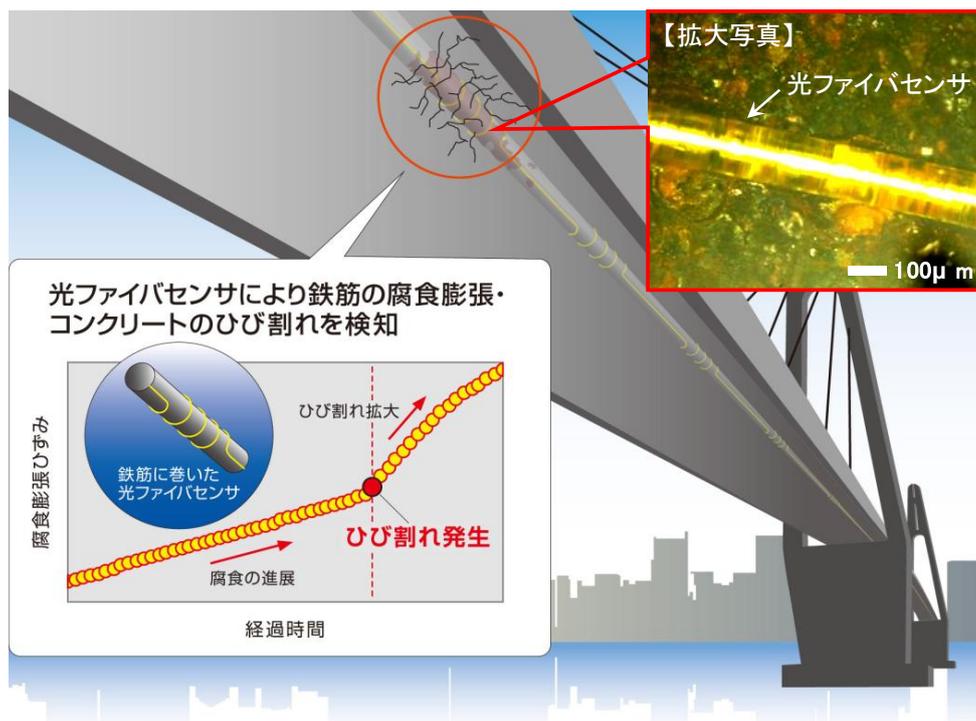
社会実装のイメージ（鉄筋の腐食膨張およびコンクリートのひび割れの検知）
